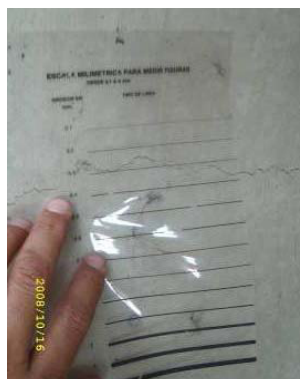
Medición de la fisura al momento del ensayo
